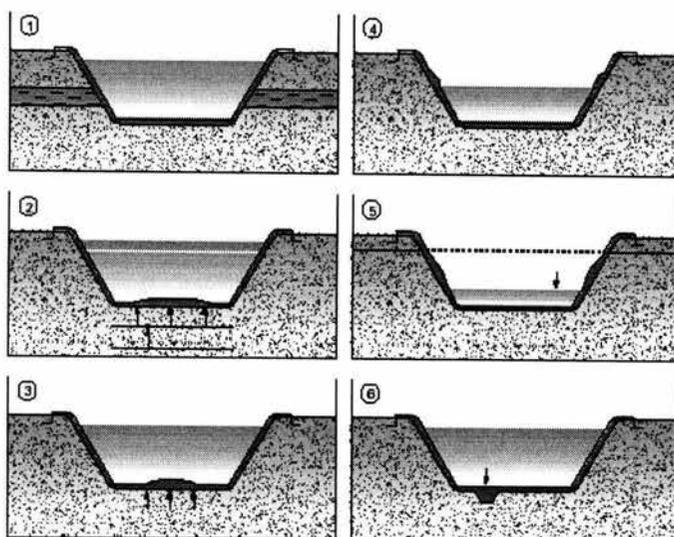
Consecuencia de la ausencia de drenaje en embalses impermeabilizados con geotextiles.
